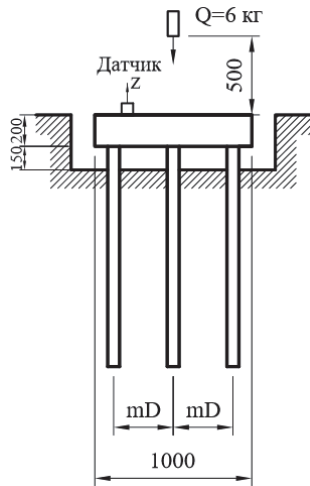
Схема экспериментальных исследований опытных фундаментов Ф-1, Ф-2, Ф-3:
